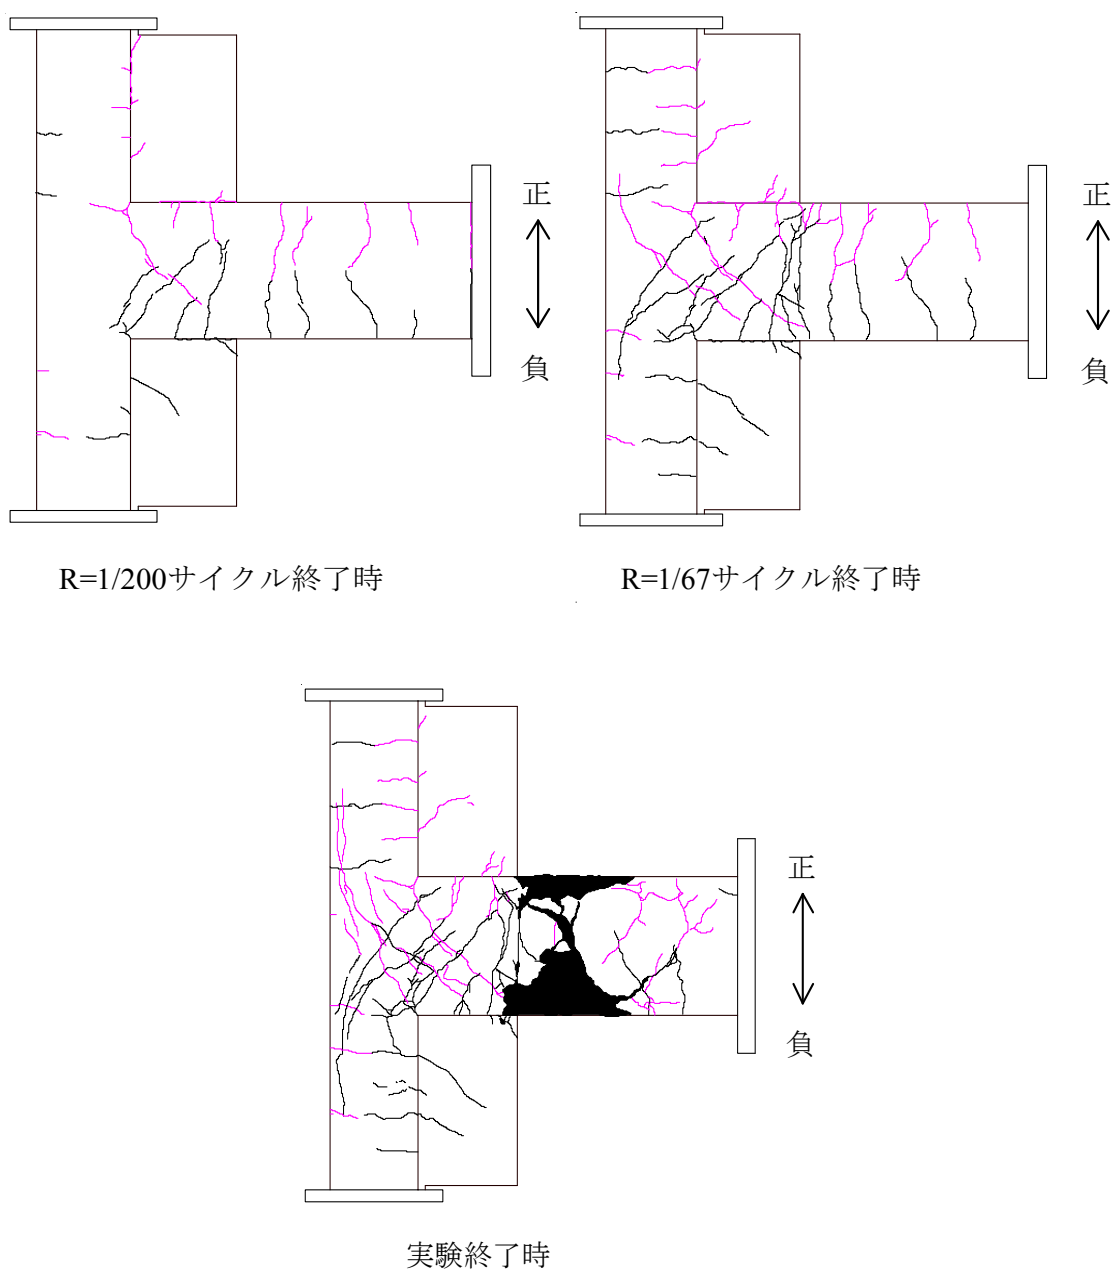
連層補強試験体のひび割れ状況
